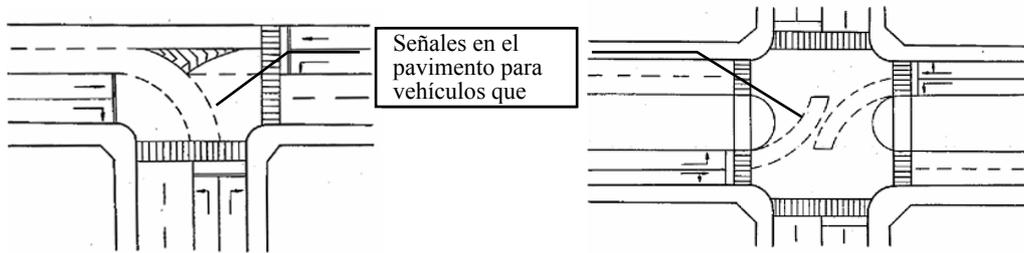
(1) Disposición Estándar para las Señales en el Pavimento donde el Funcionamiento del Carril será modificado
